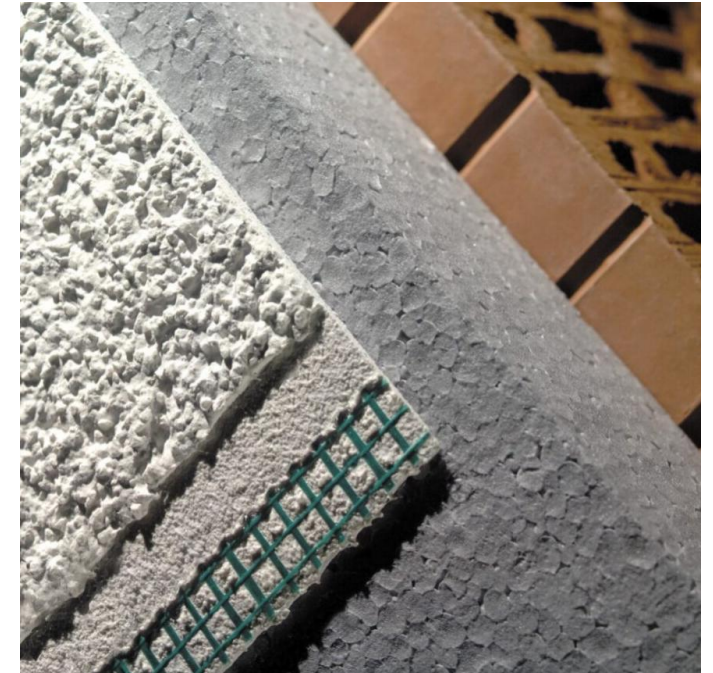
Wärmedämm-Verbundsystem bestehend aus brandschutzrelevantem Putzsystem und EPS-Wärmedämmstoff
